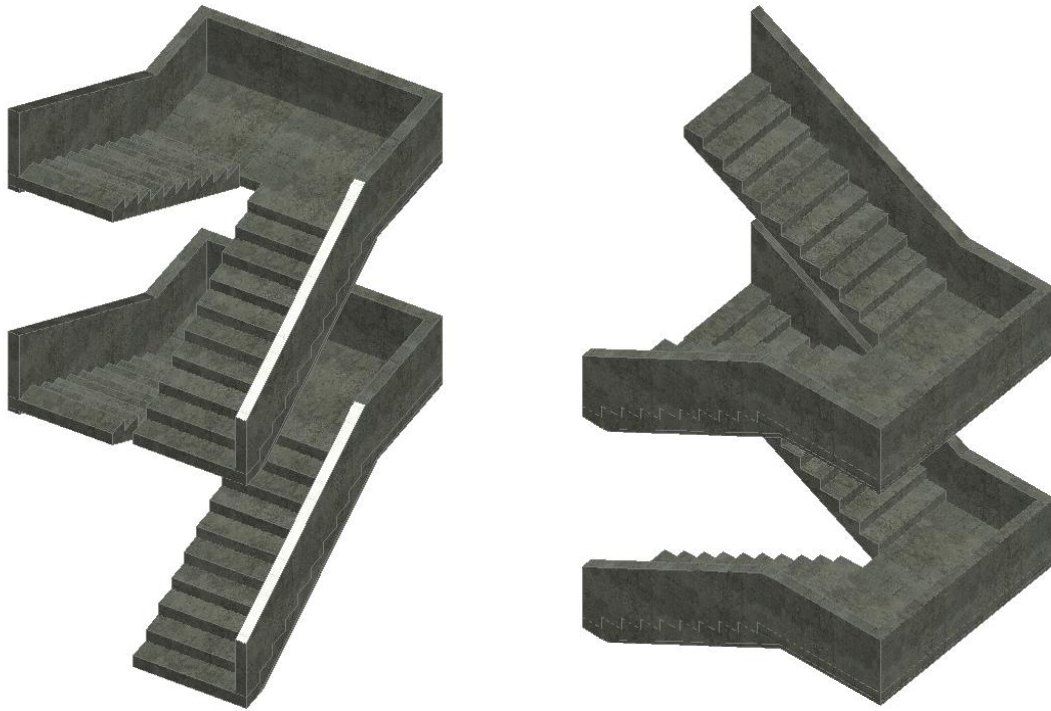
Vista general del elemento de las escaleras, incluyendo las existentes y las nuevas
